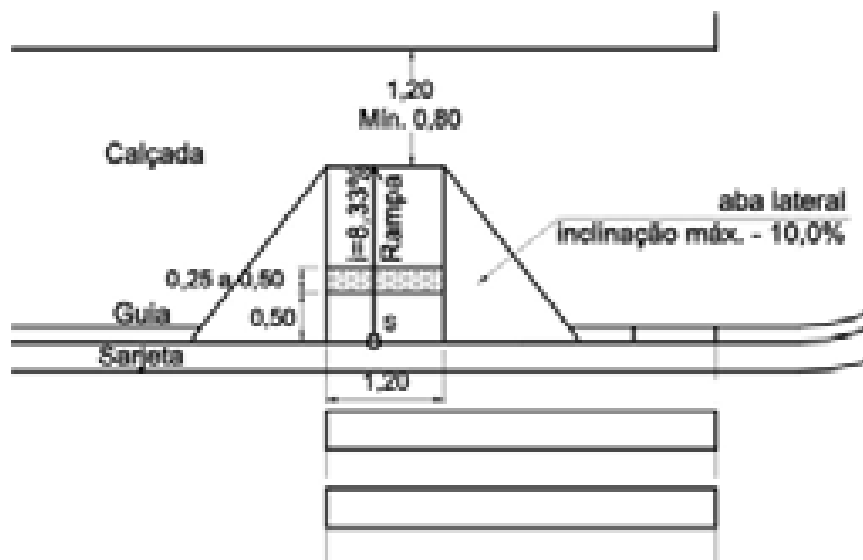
Vista superior e dimensões mínimas, em metros, dos rebaixamentos das calçadas
